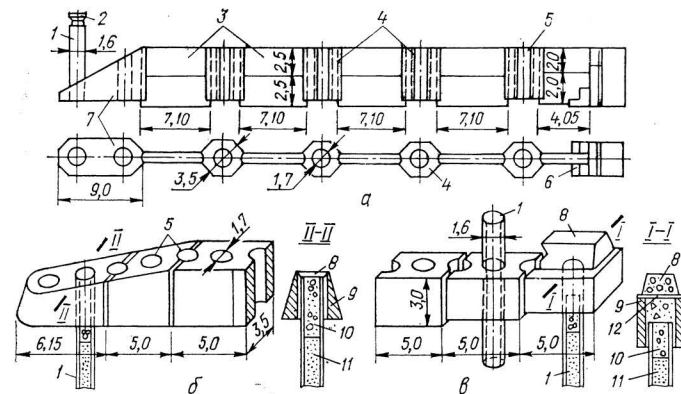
Сборные конструкции бун на колоннах-оболочках:
